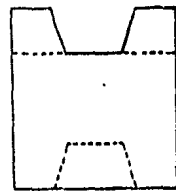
ELEMENTOS DE CONCRETO.
